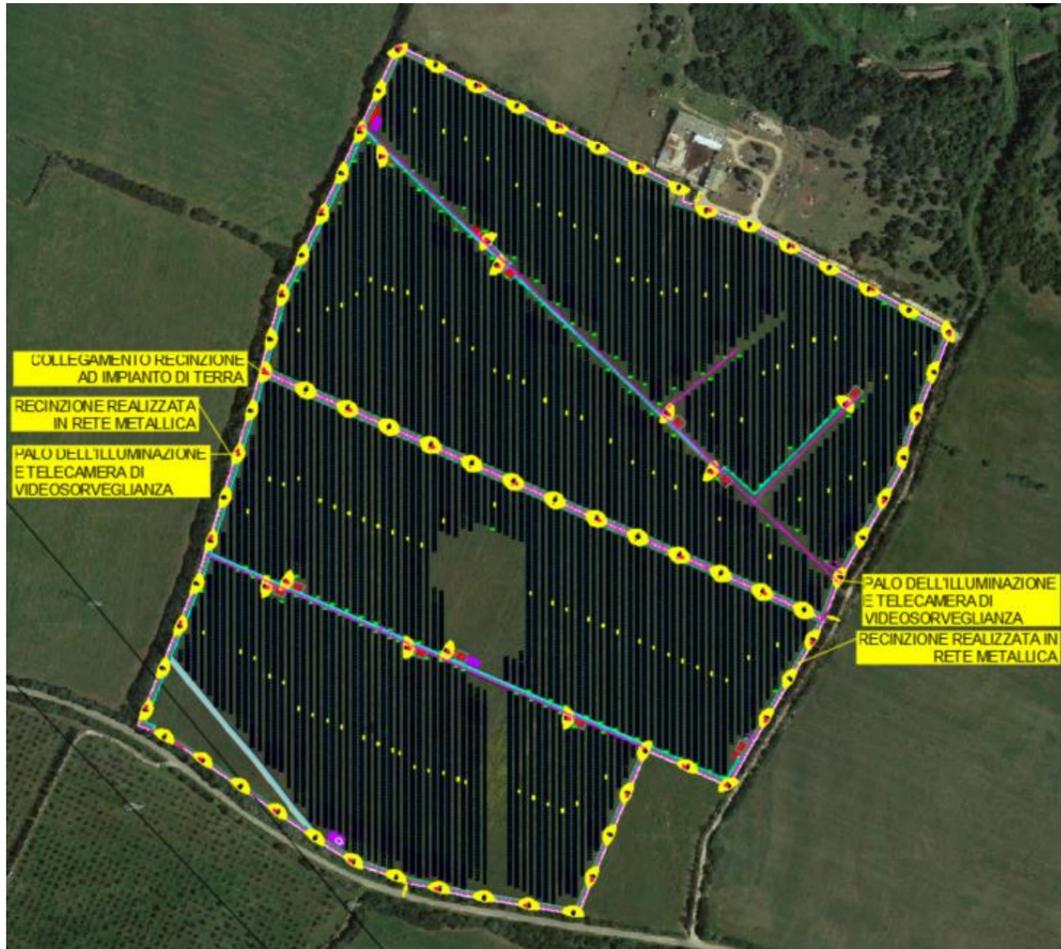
Planimetria illuminazione e videosorveglianza Impianti Bassu 1 e 2
